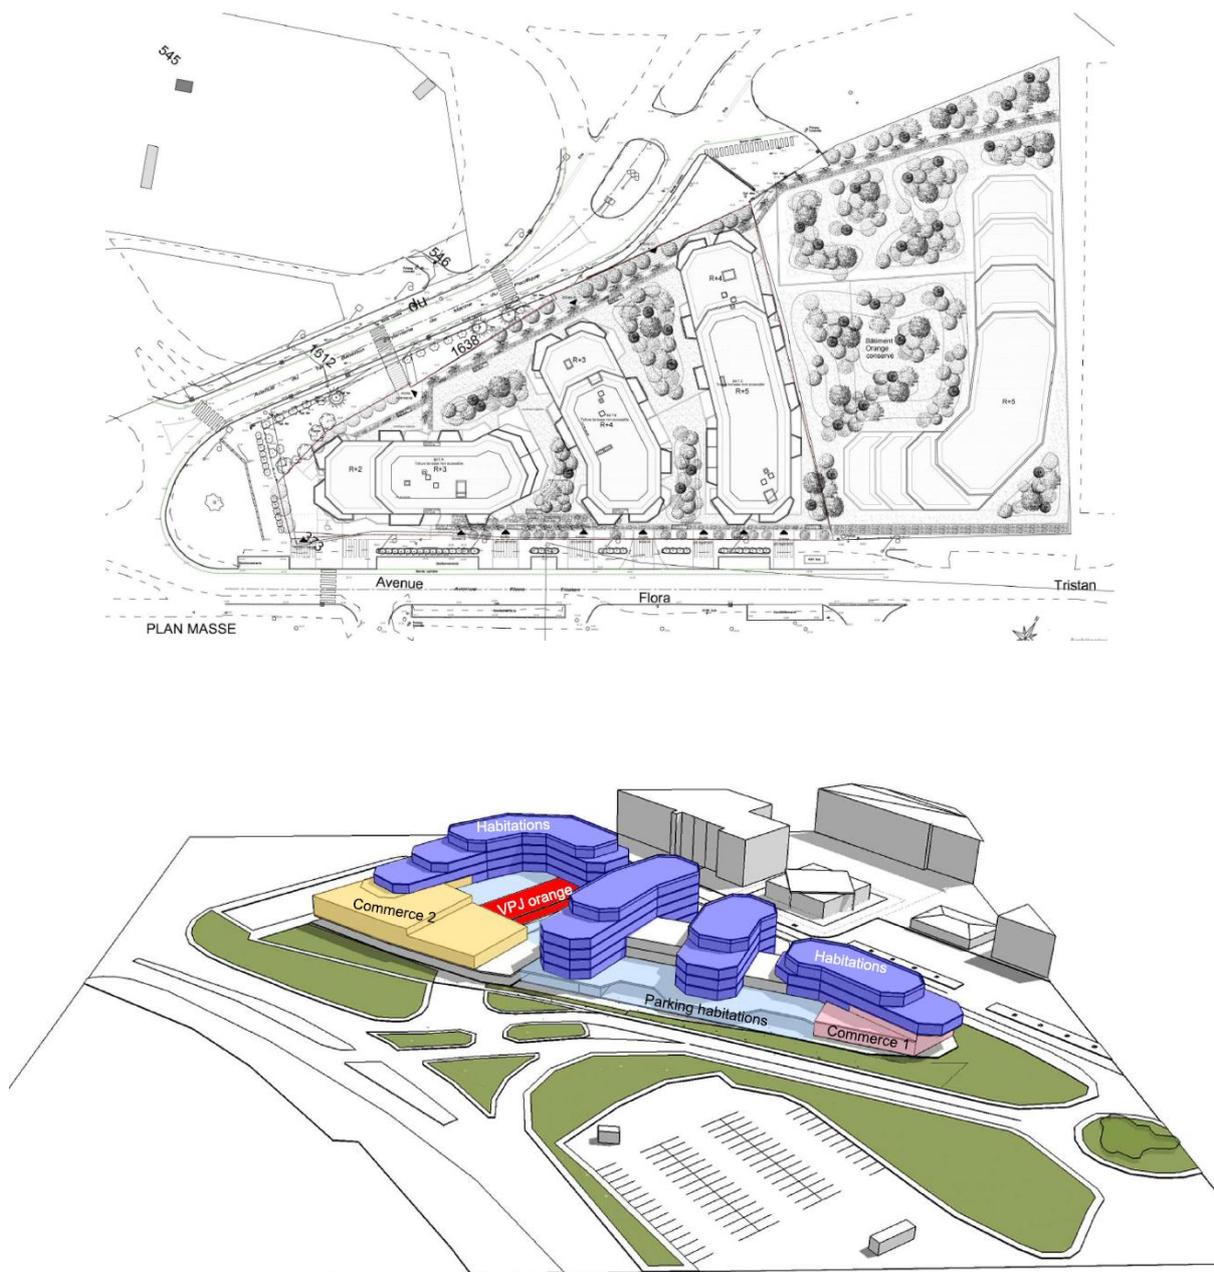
Plan de composition – Avenue Flora TRISTAN
